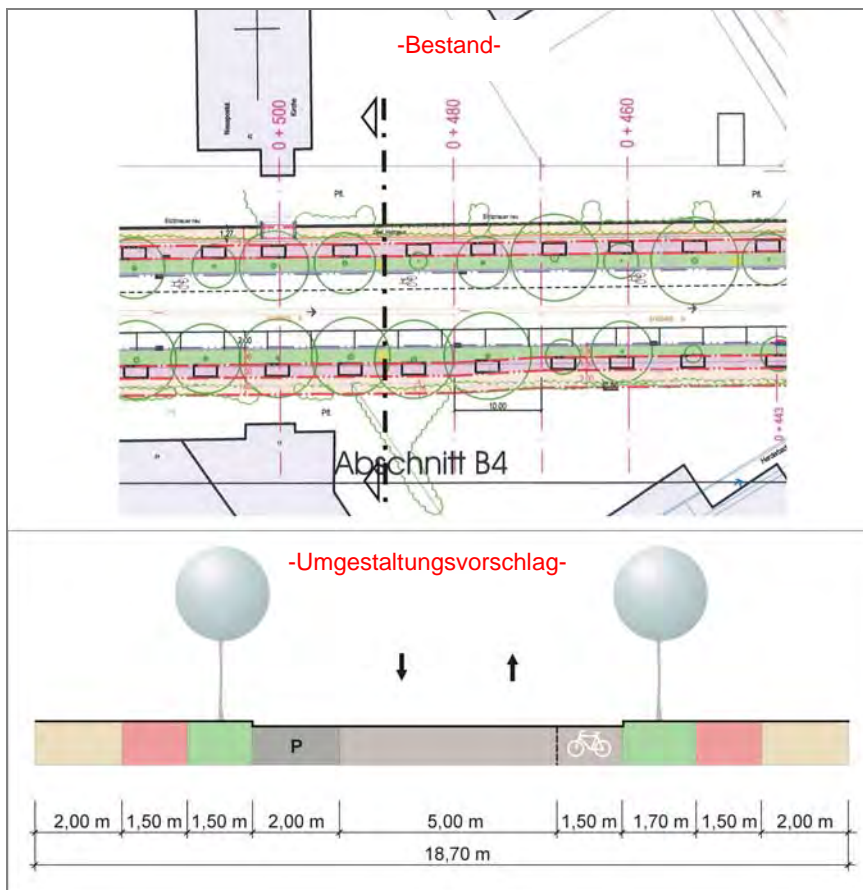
Prinzregentenstraße – Abschnitt Kloeckelstraße/Langbehnstraße
